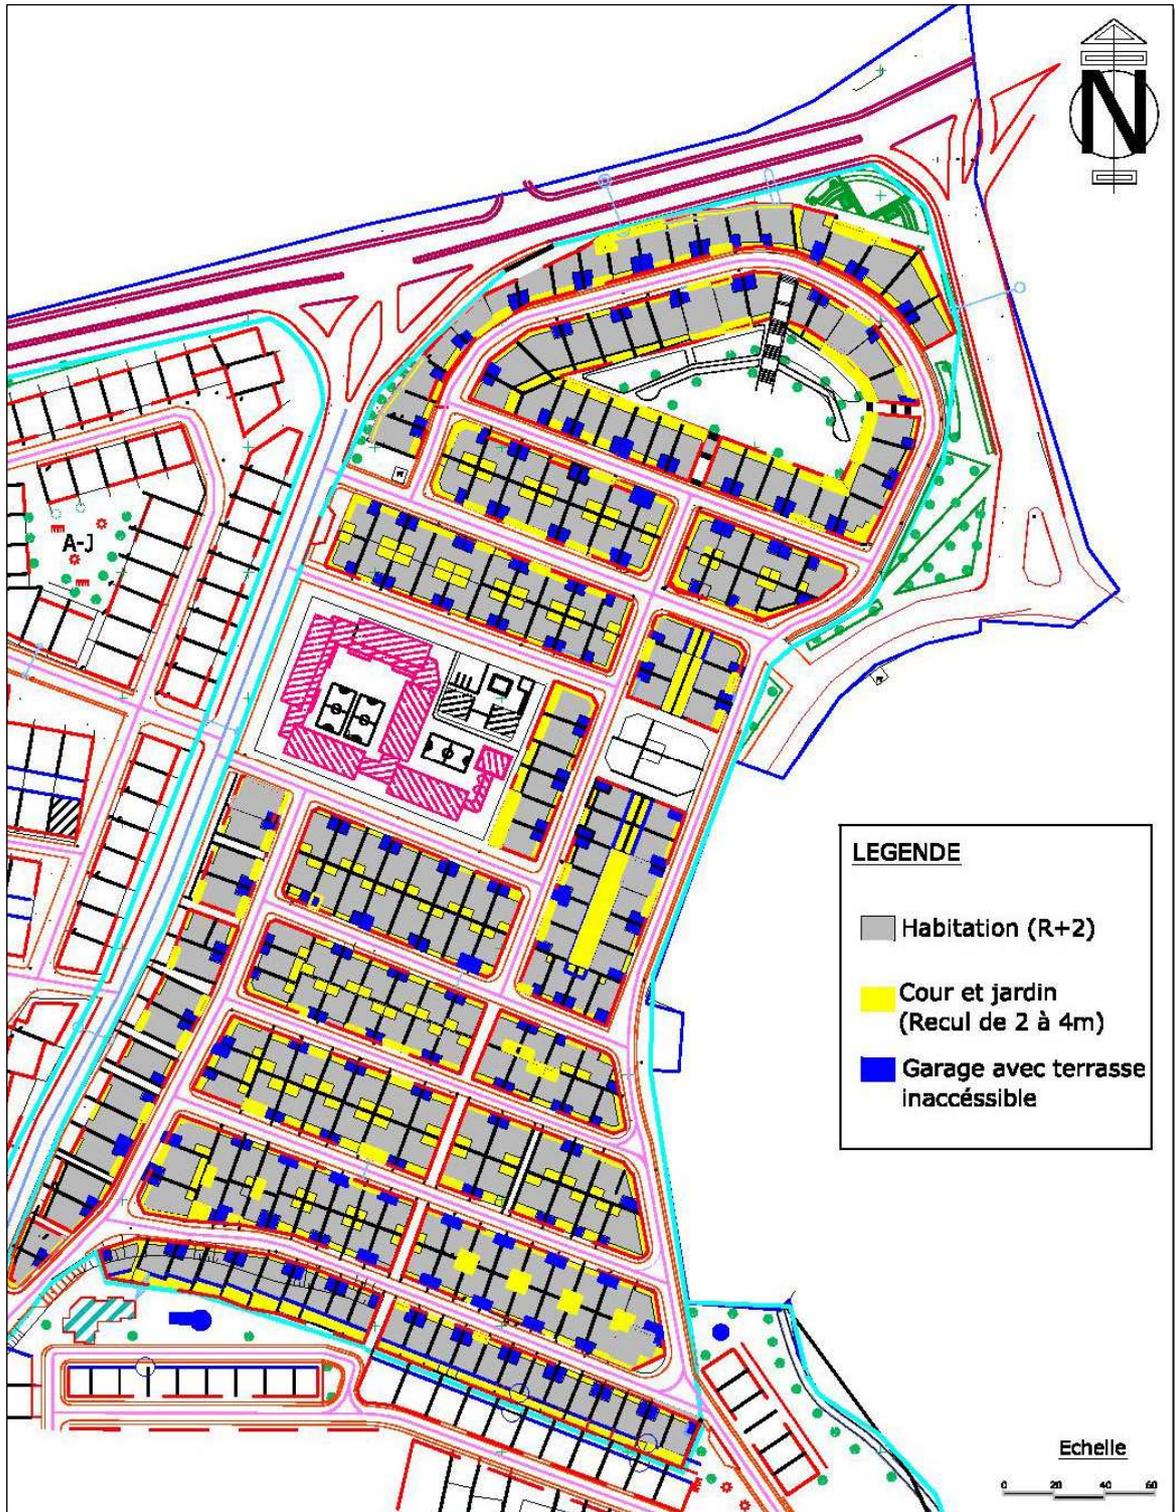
Plan réglementaire du lotissement Bourmel 04 à Jijel
